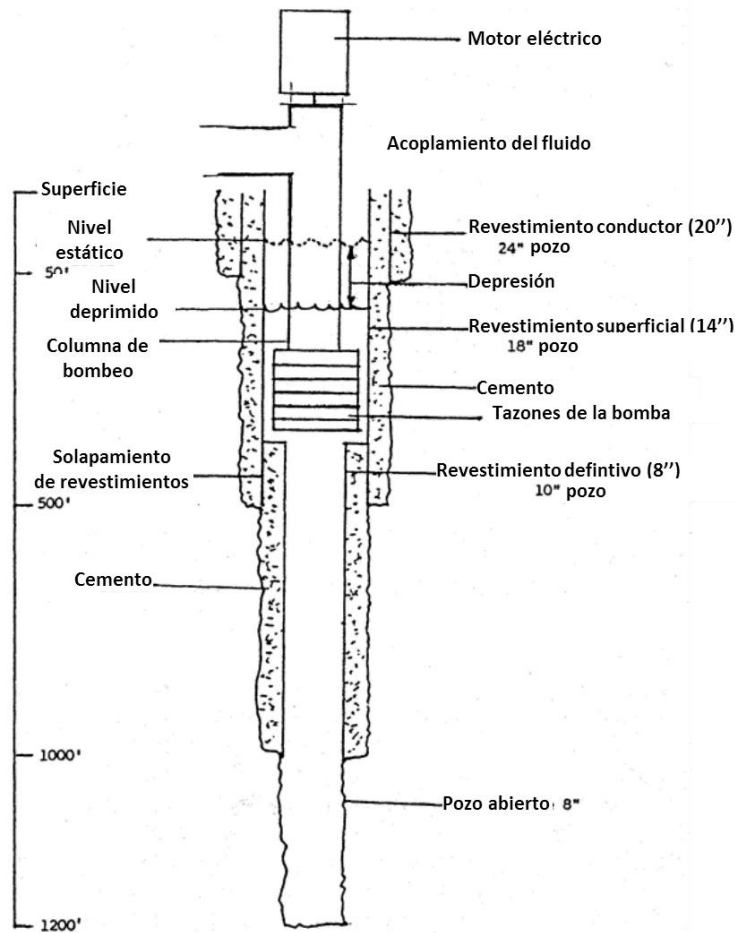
Detalles típicos de la construcción de un pozo geotermal. Fuente: Adaptado de [40].
